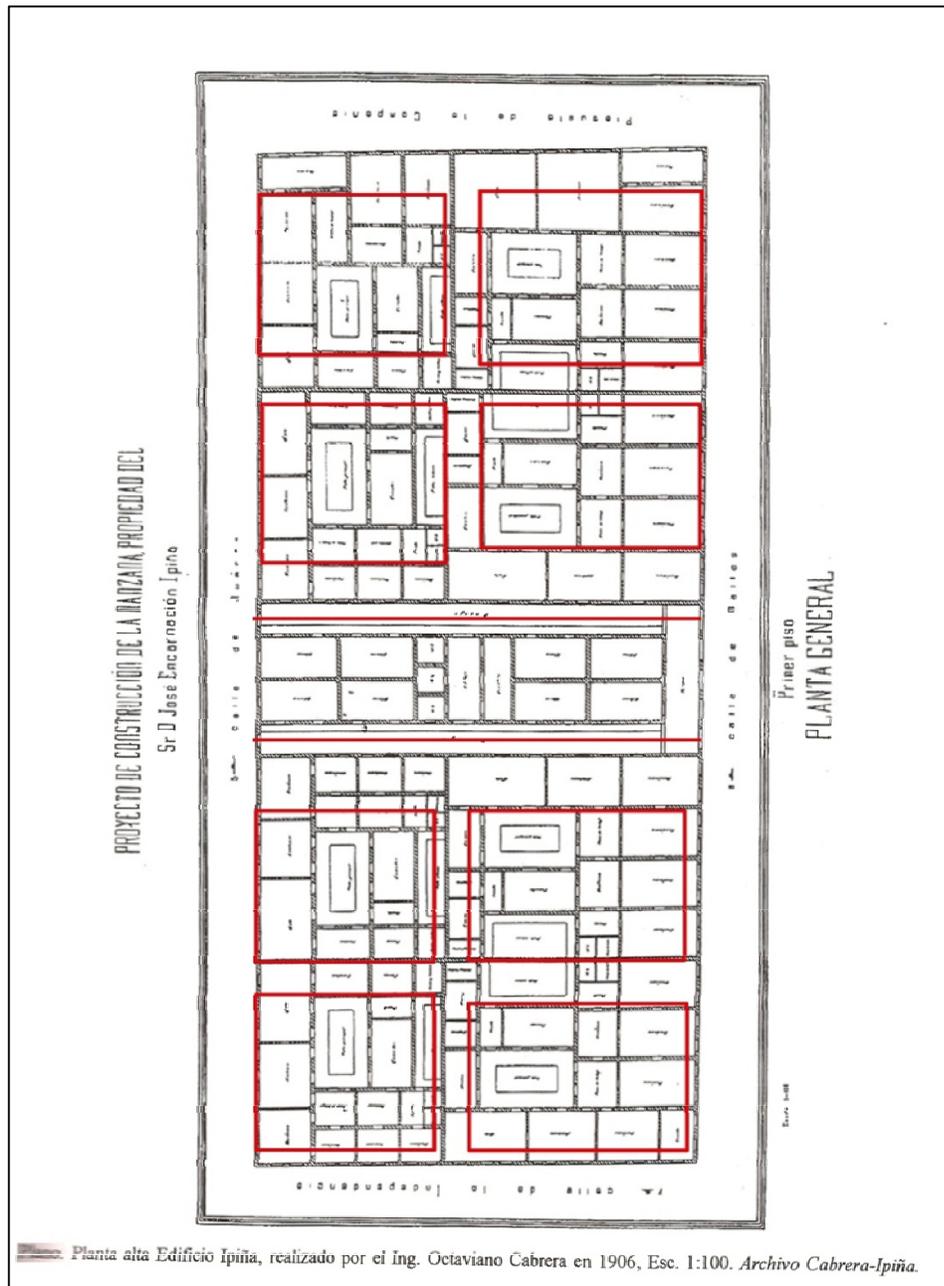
Plano. Planta alta del Edificio Ipiña, con la misma disposición de los corredores que en planta baja. Dividen simétricamente los tramos arquitectónicos, en los que se encuentran dispuestas cuatro espaciosas áreas departamentales por tramo arquitectónico. Imagen: Dr. Jesús V. Villar Rubio.
